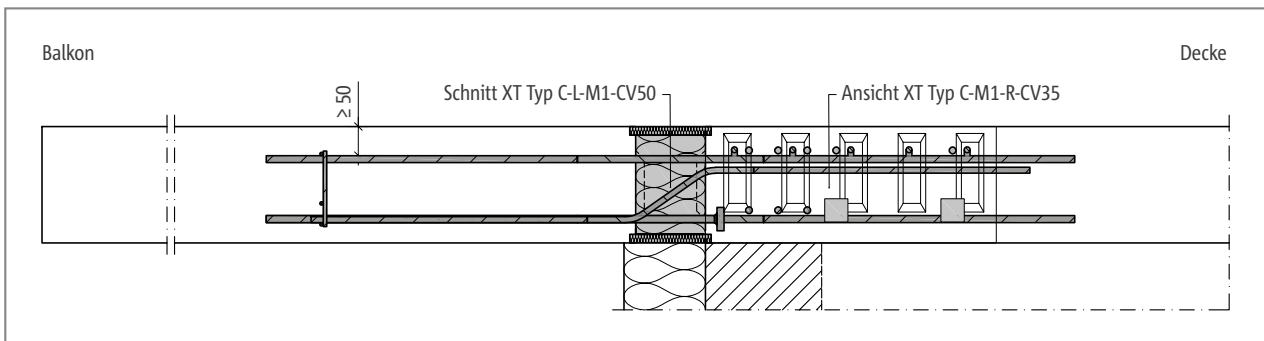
Schöck Isokorb® XT Typ C: Außenecke bei WDVS (Ansicht XT Typ C-L-CV50; Schnitt XT Typ C-R-CV35)
